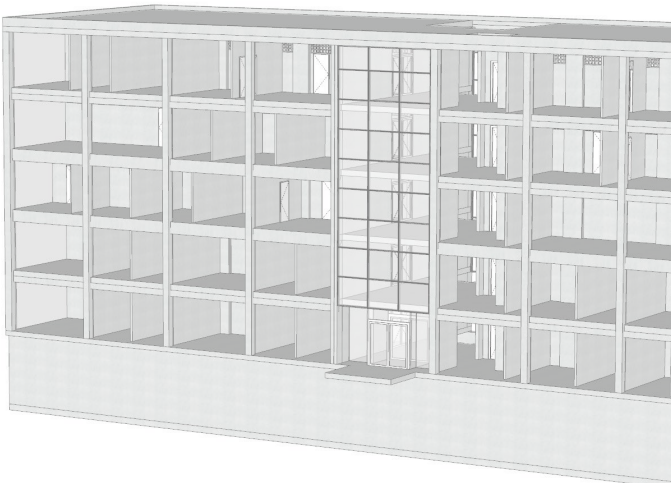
Entfernen der nichttragenden Fassadenstruktur
